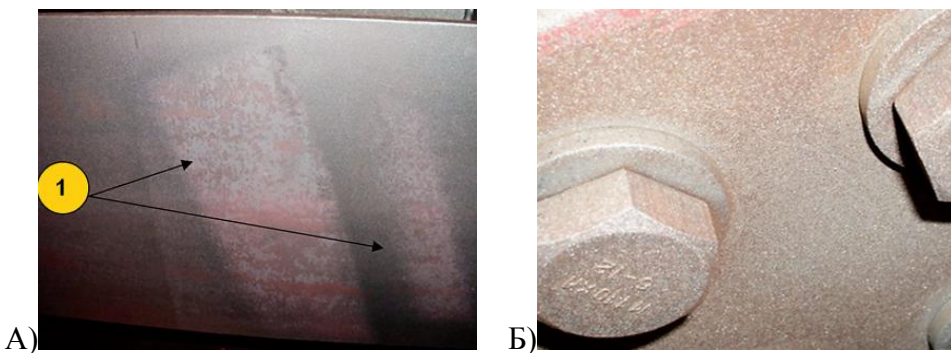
А – Остатки прокатной окалины, 6Б – Остатки ржавчины
